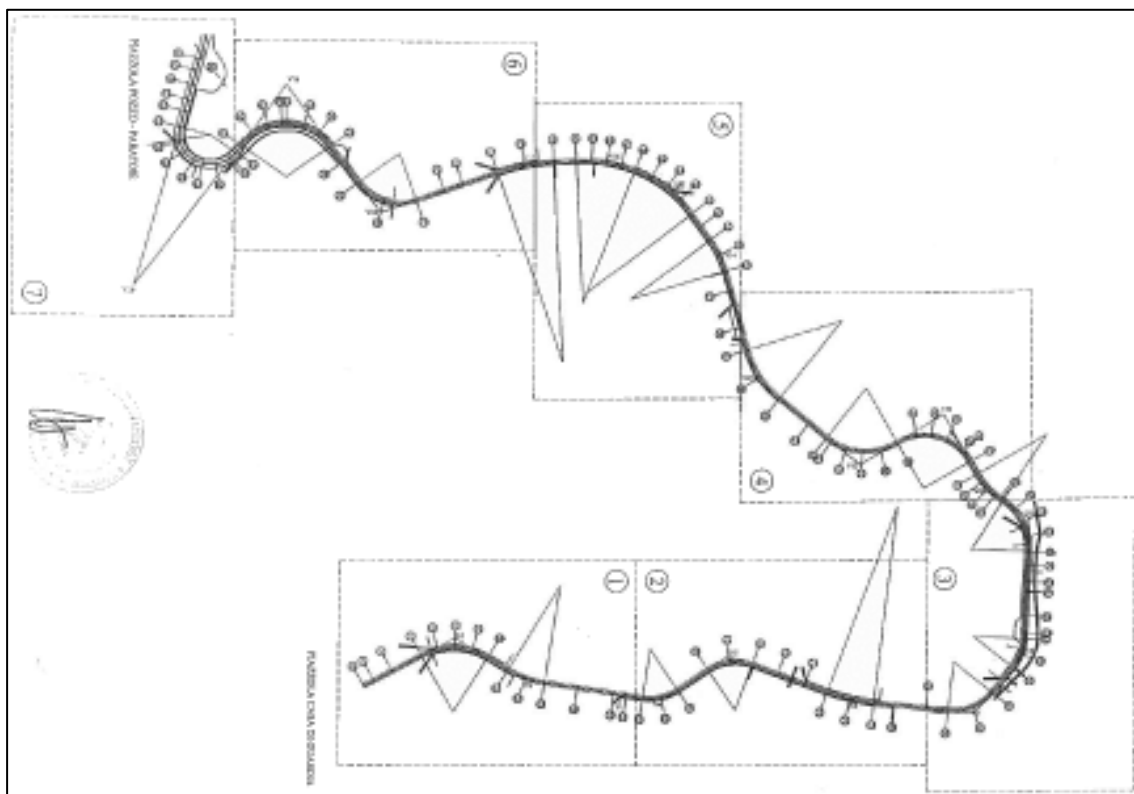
Planimetria della strada di collegamento tra la casa di guardia e la torre di manovra delle paratoie
